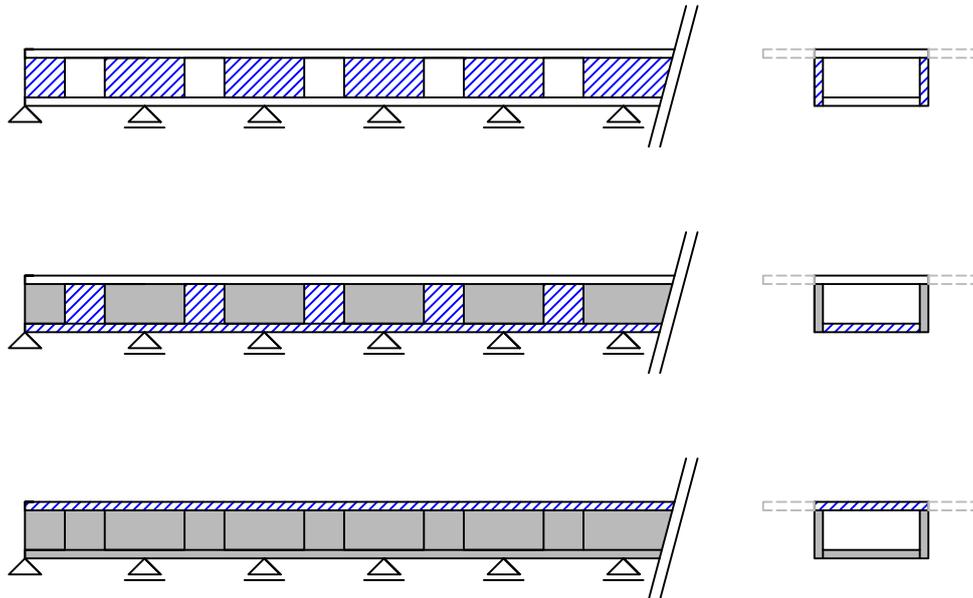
Ablauf des Herstellungsvorganges des fertigen Tragwerkes nach dem Einschub - Betonagevariante D aus [1]
